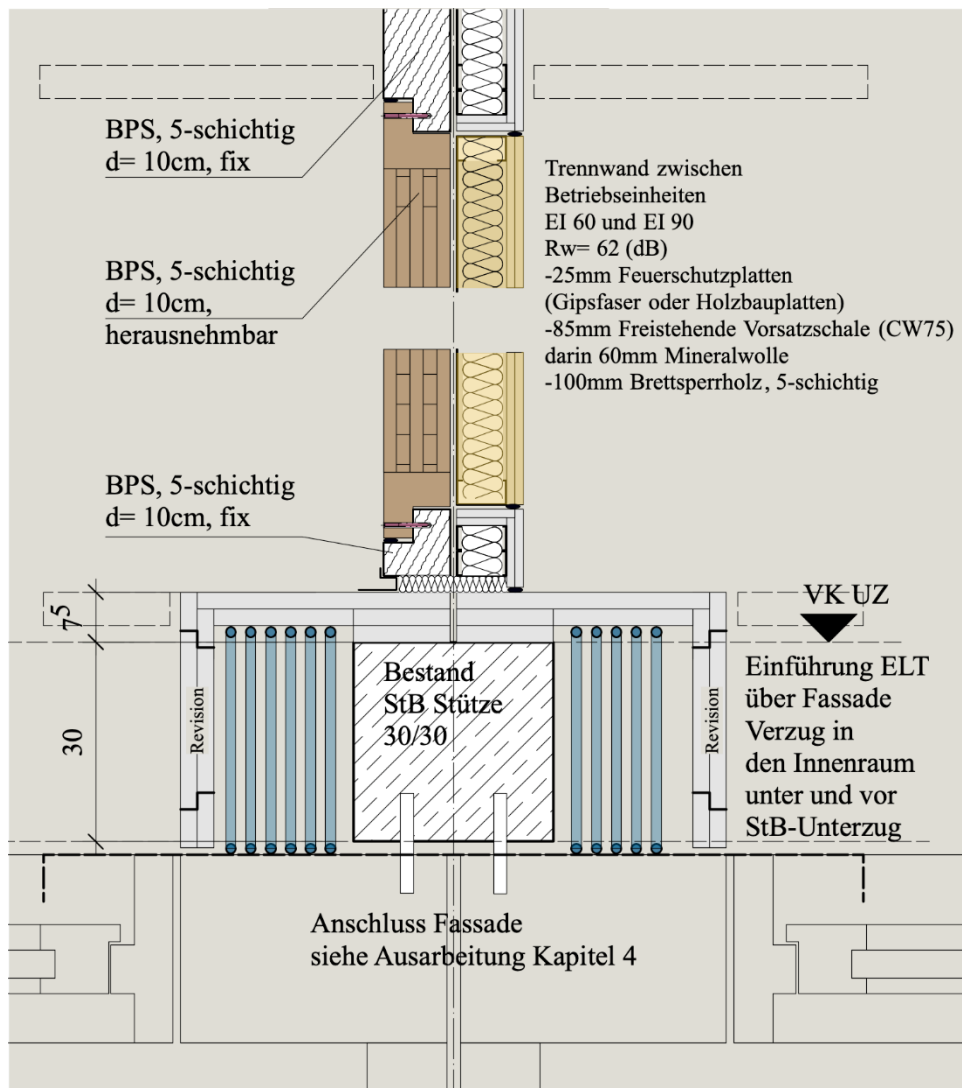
Darstellung Grundriss Anschluss zweischalige Trennwand an Fassadenstütze mit Einführung Elektroleitung aus Fassadensystem
